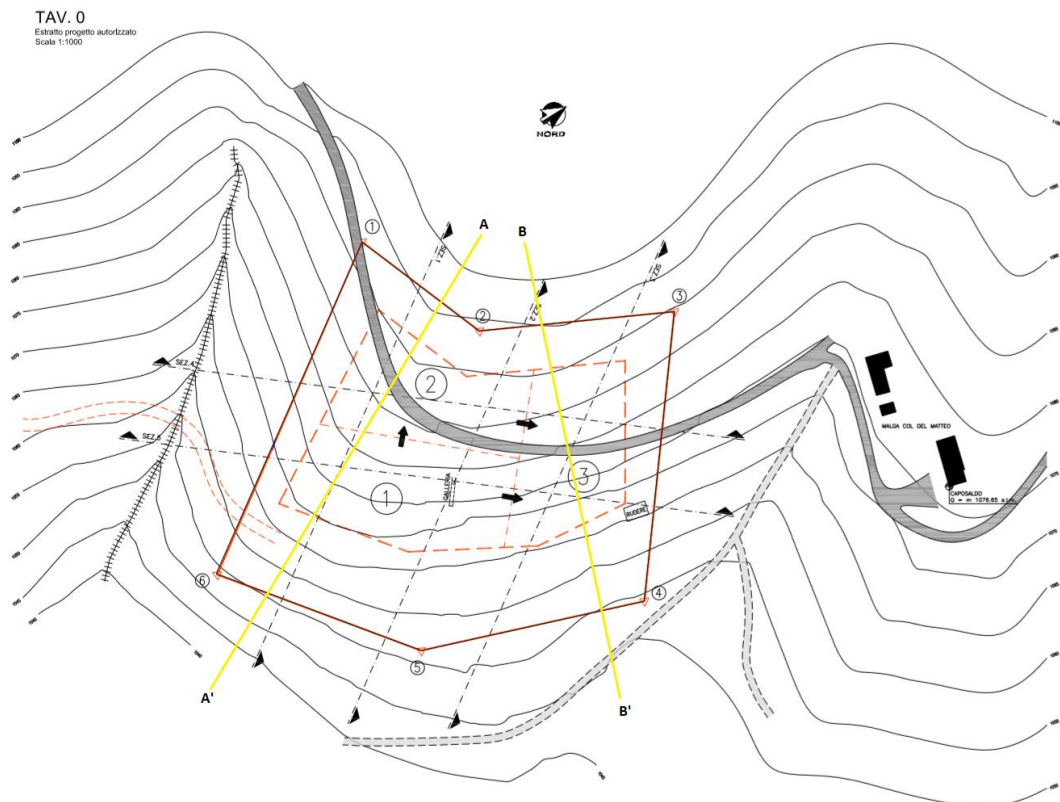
Planimetria raffigurante la concessione del polo 3 nella quale è evidenziata dalle linee gialle la posizione delle sezioni sottoposte all'analisi DEM.
